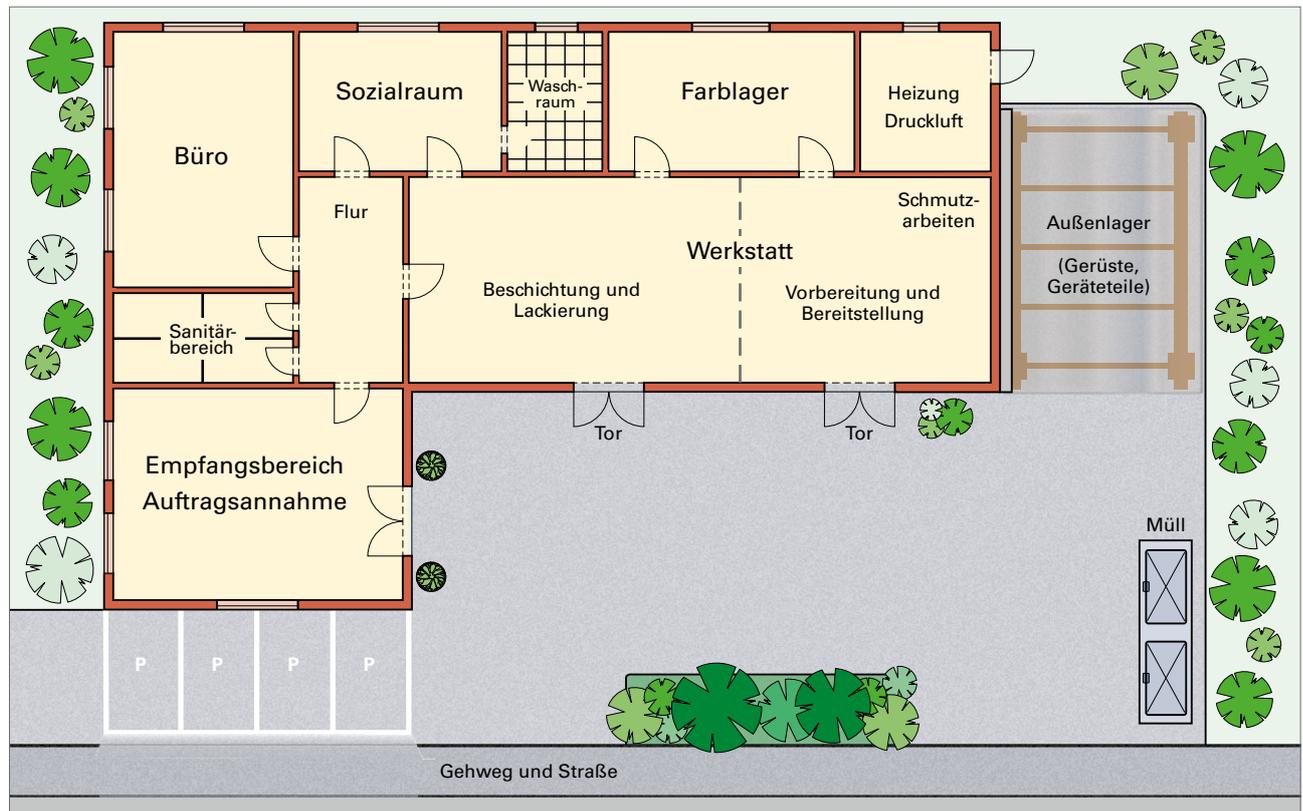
Möglicher Grundriss eines Malerbetriebes
